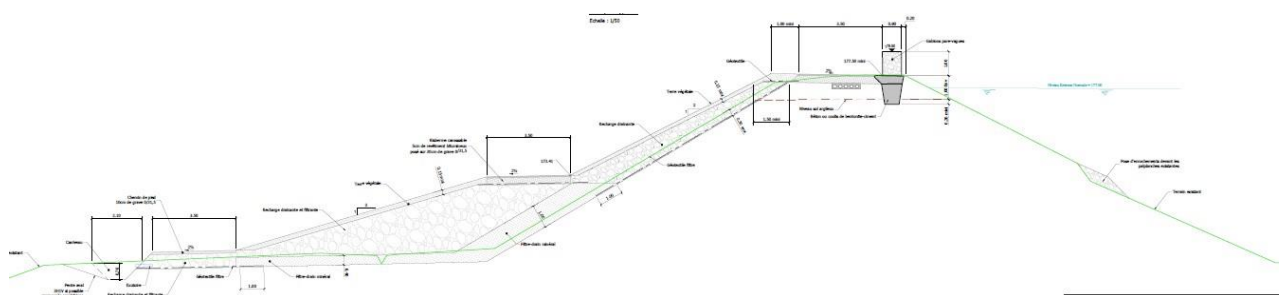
Coupe type de reprise du barrage avec en vert le profil actuel (Source : dossier)
